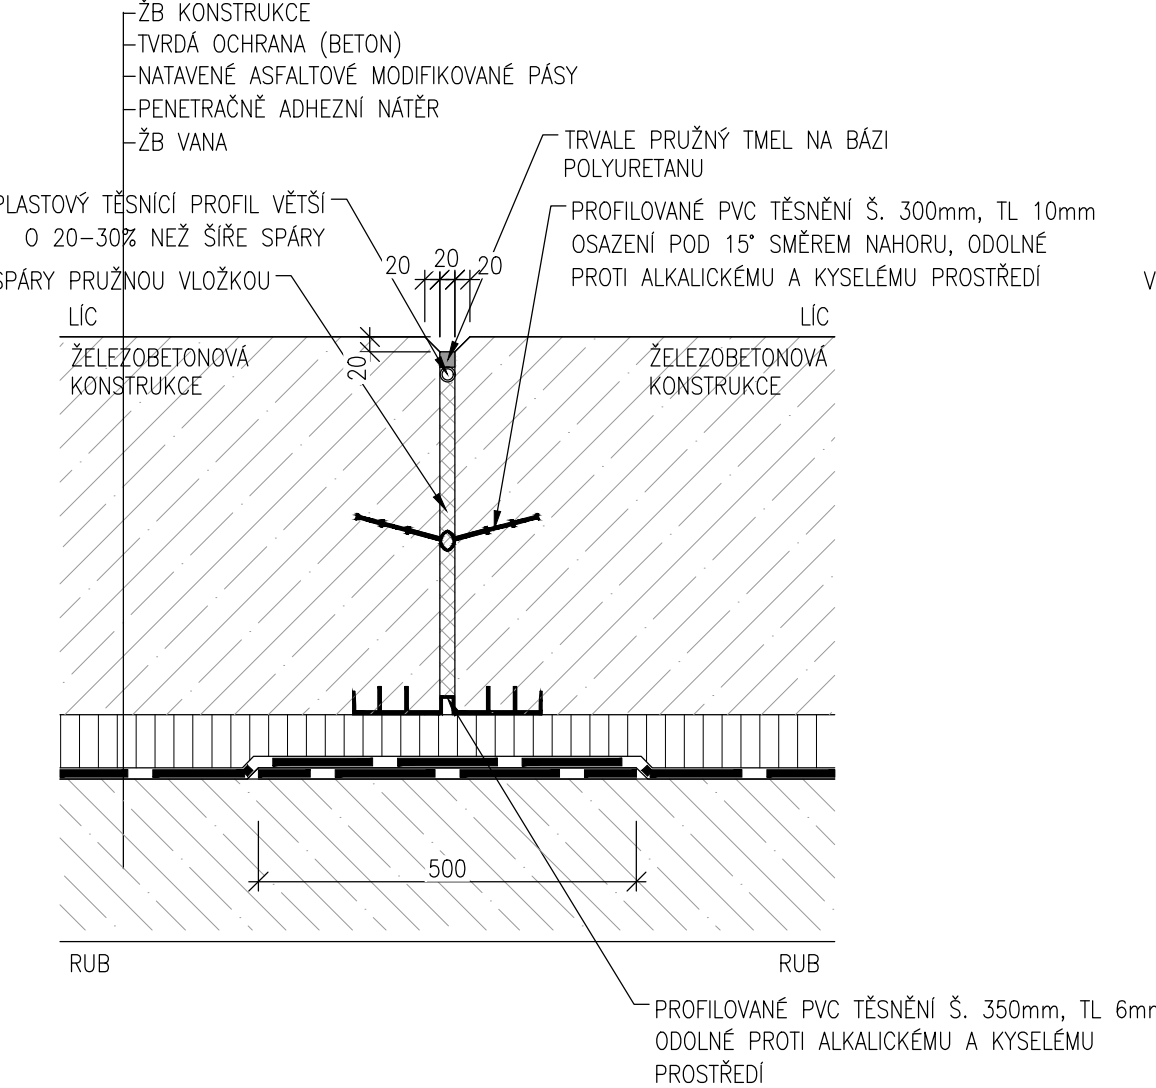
DETAIL ÚPRAVY DILATAČNÍ SPÁRY VE STĚNĚ
